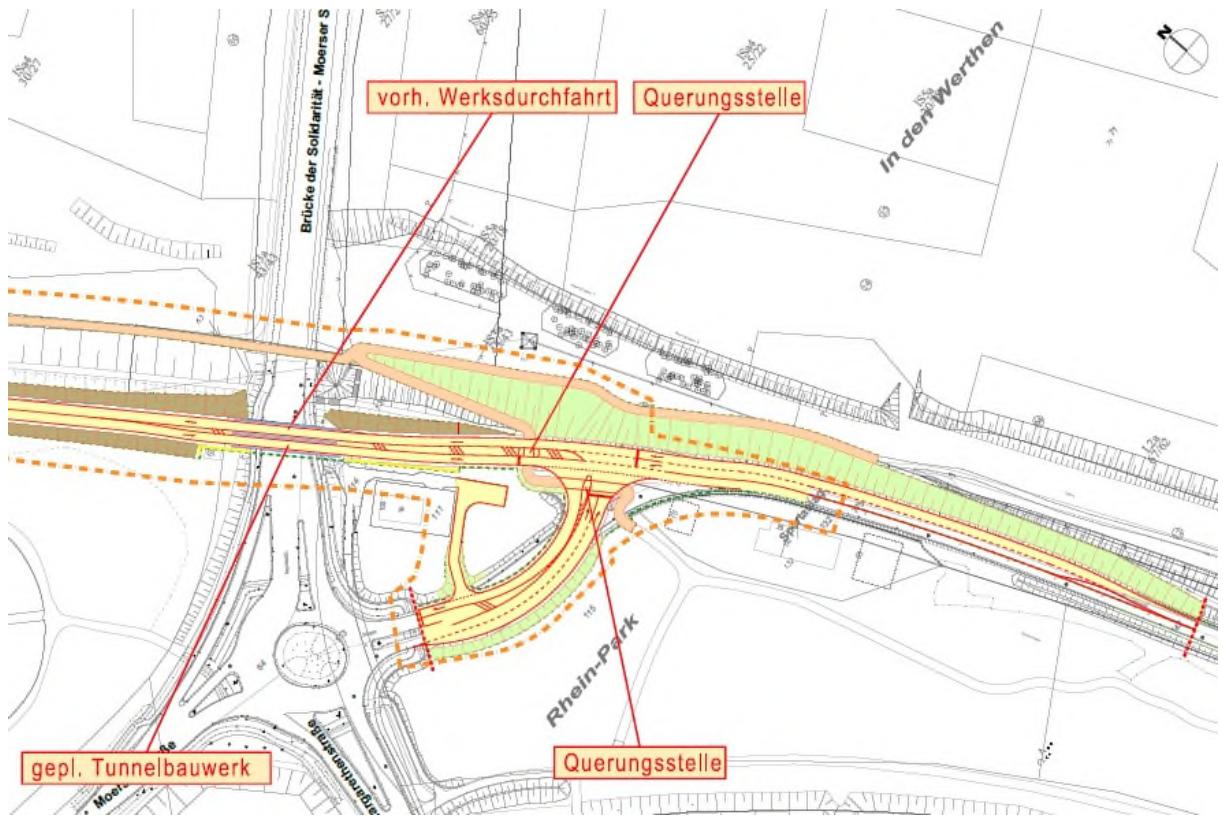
Anschlusspunkt Süd – Vorzugsvariante AS2 Brücke
